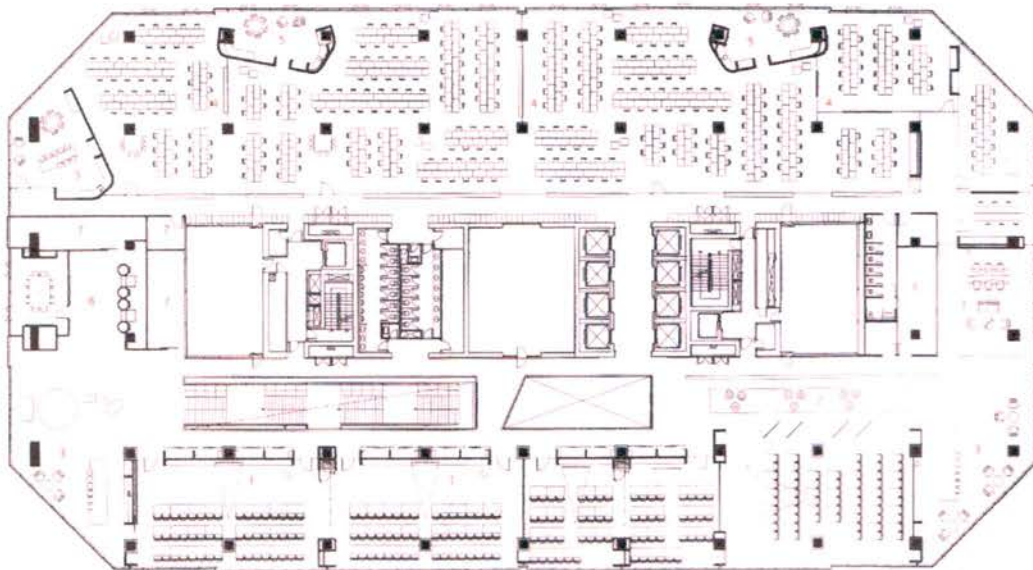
แสดงบริเวณ 1th Floor Plan
